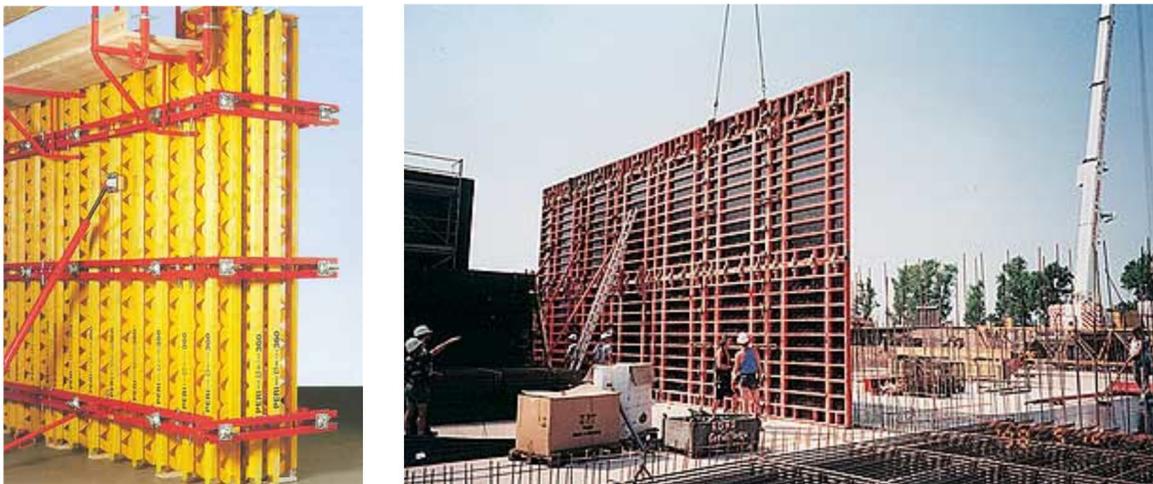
Erstellung der Stahlbetonbauwerke vor Ort/Schalungssysteme
